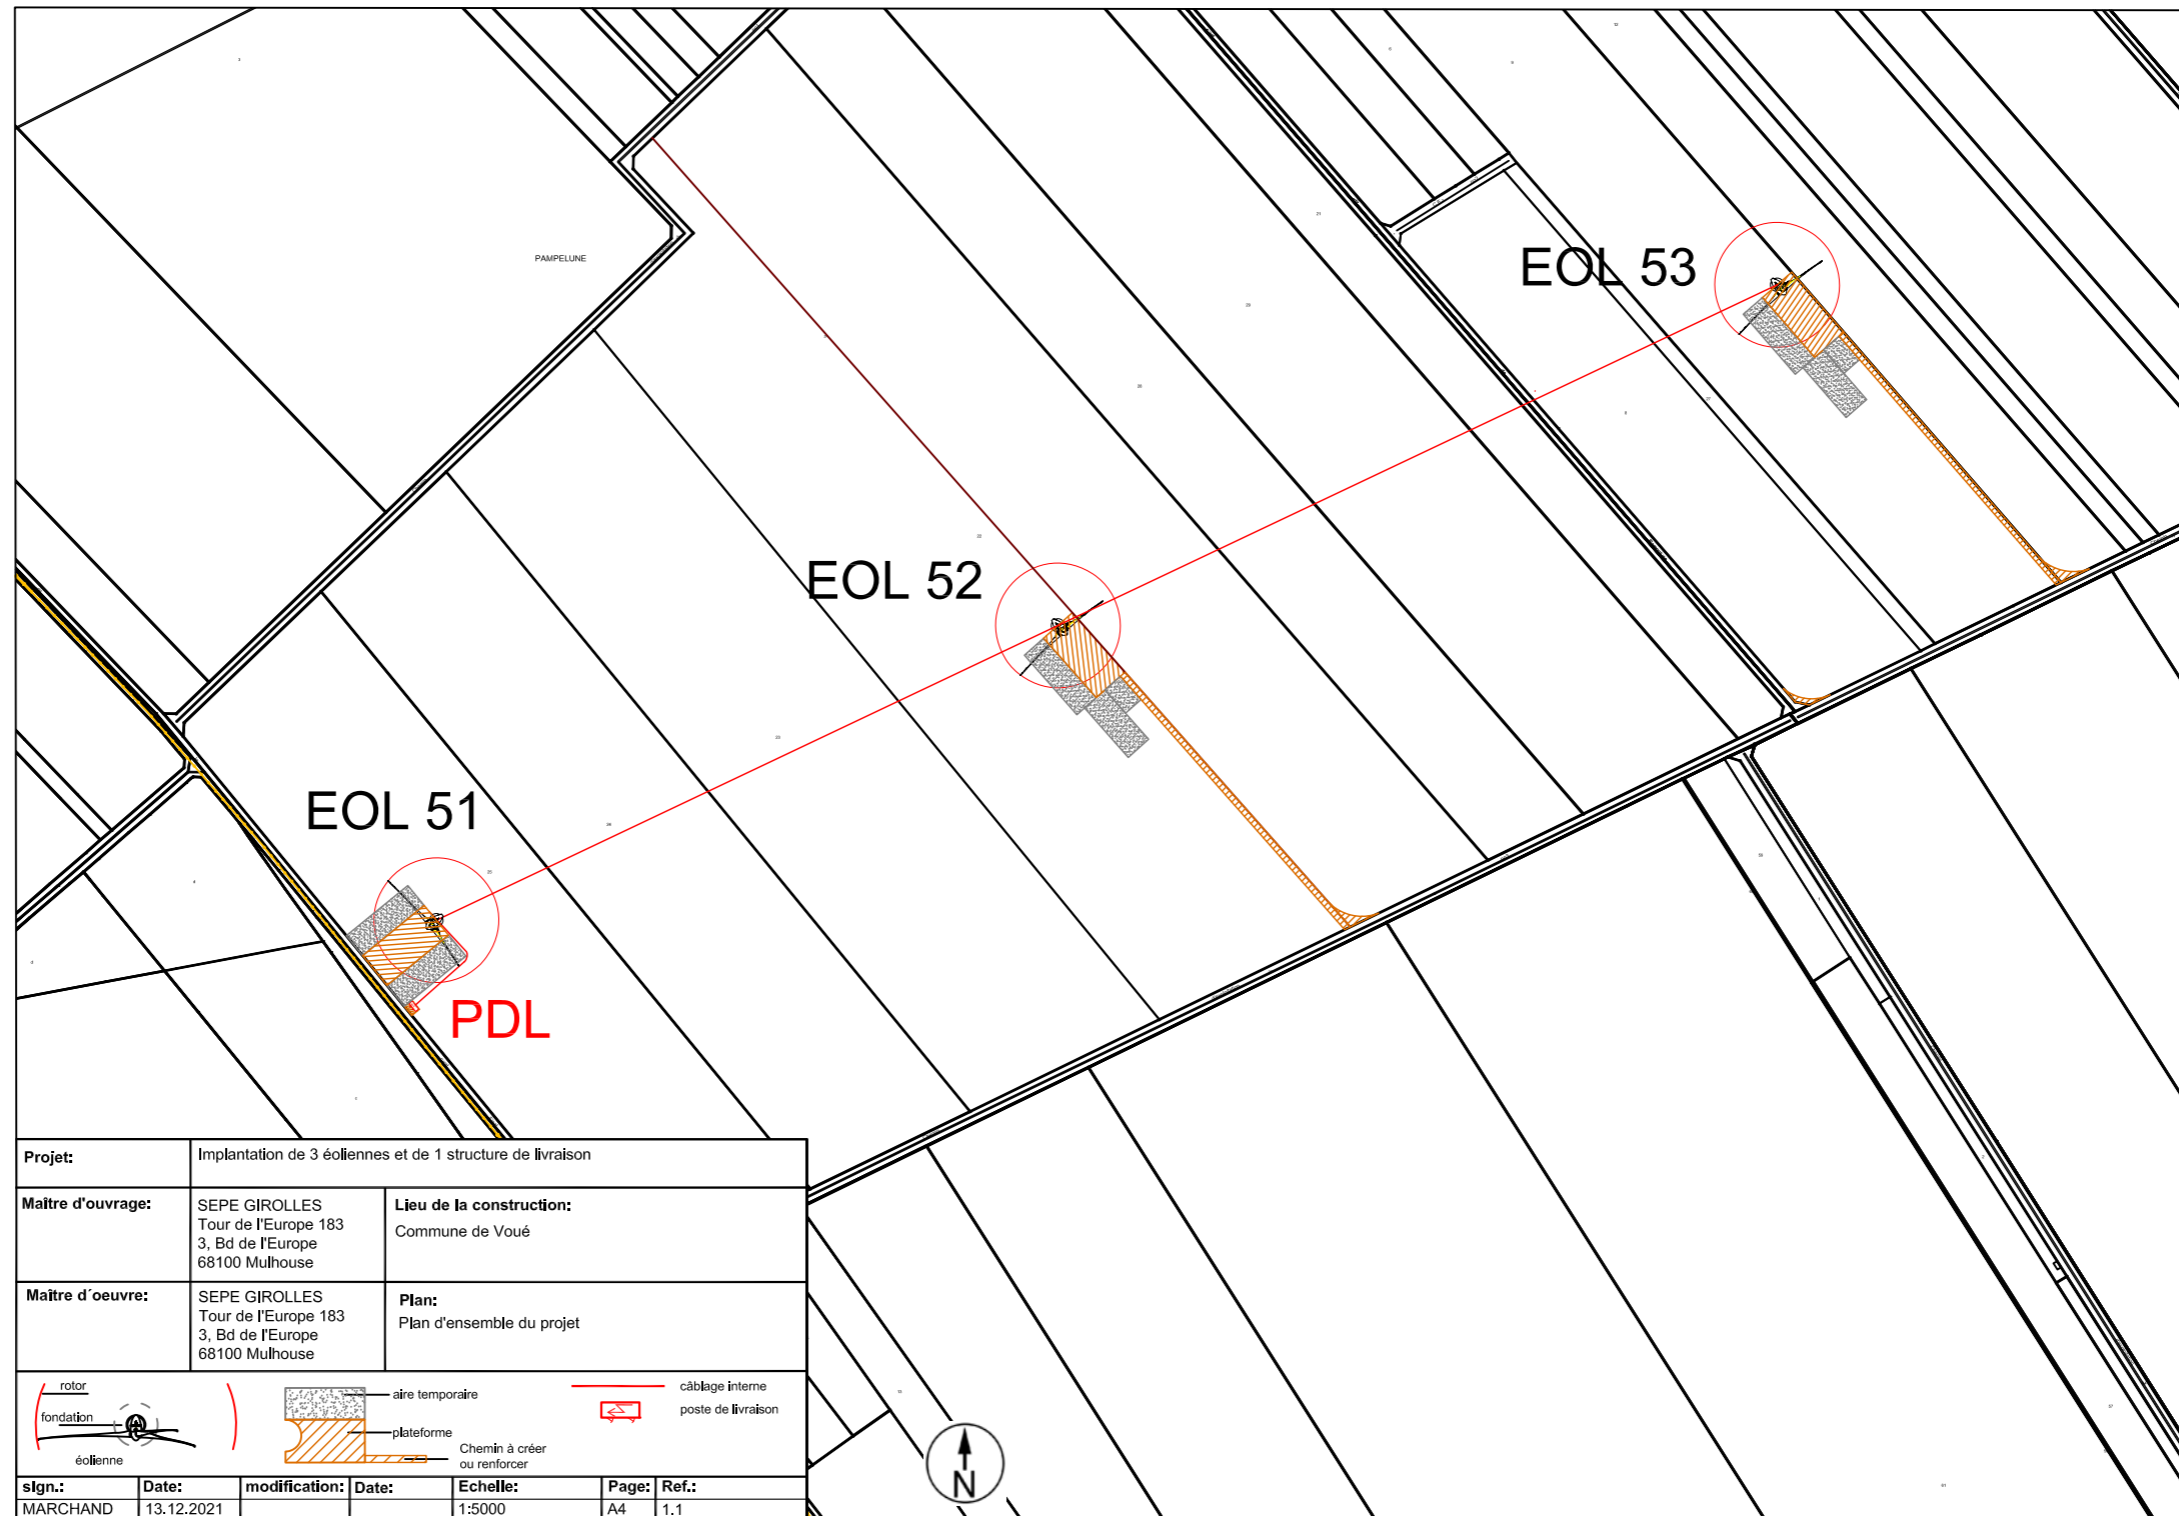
Carte de l'implantation des éoliennes sur le plan cadastral
